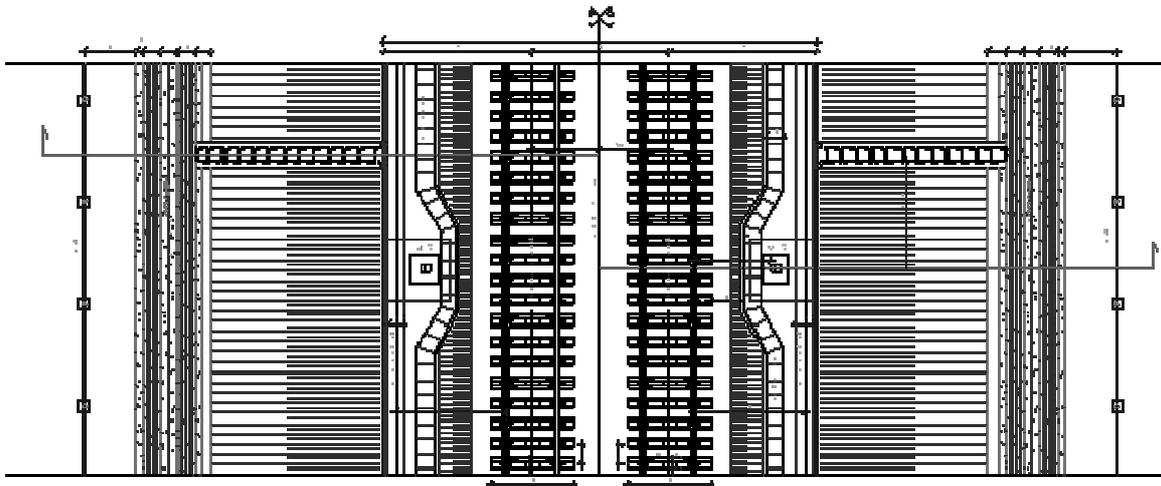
Stralcio planimetrico per sezione tipo ferroviaria in rilevato a doppio binario (piattaforma in retto) con $H_{rl} \leq 6,00$ m
